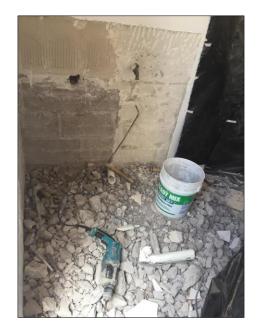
Demolición de pila que ocupaba 2.35 m² de pared
